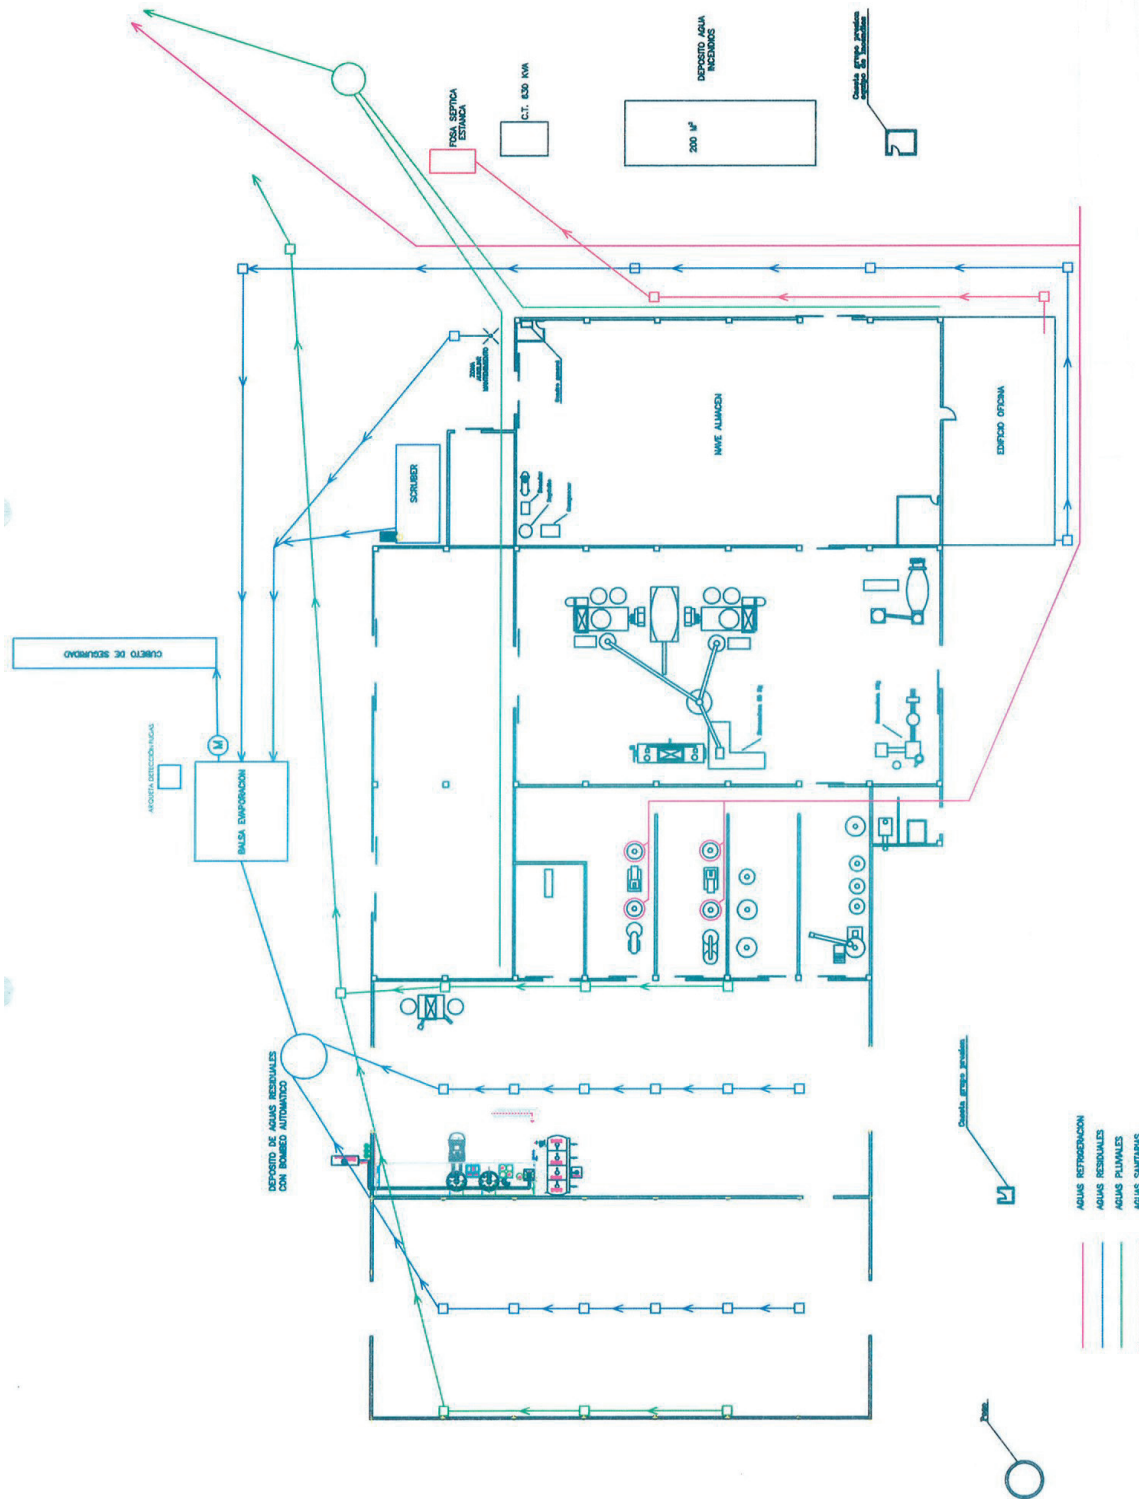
Plano en planta de la instalación, con las redes de saneamiento.
